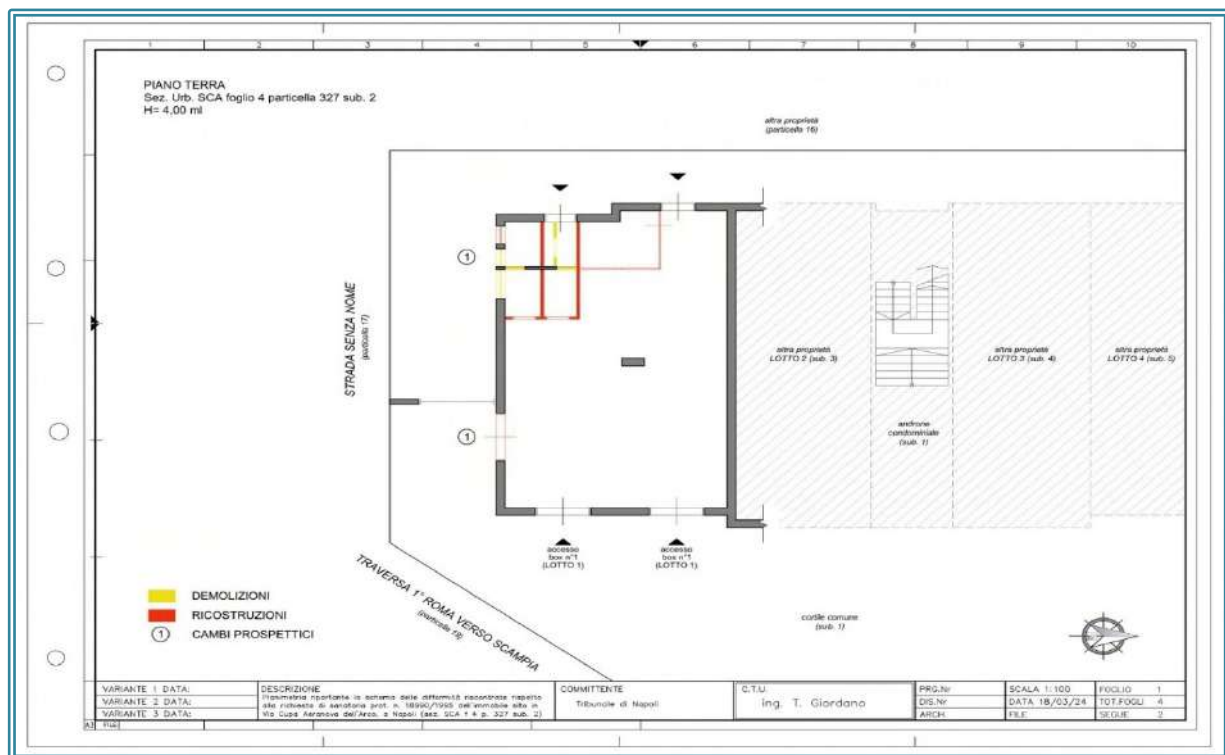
Schema in cui si evidenziano le difformità (LOTTO 1)
